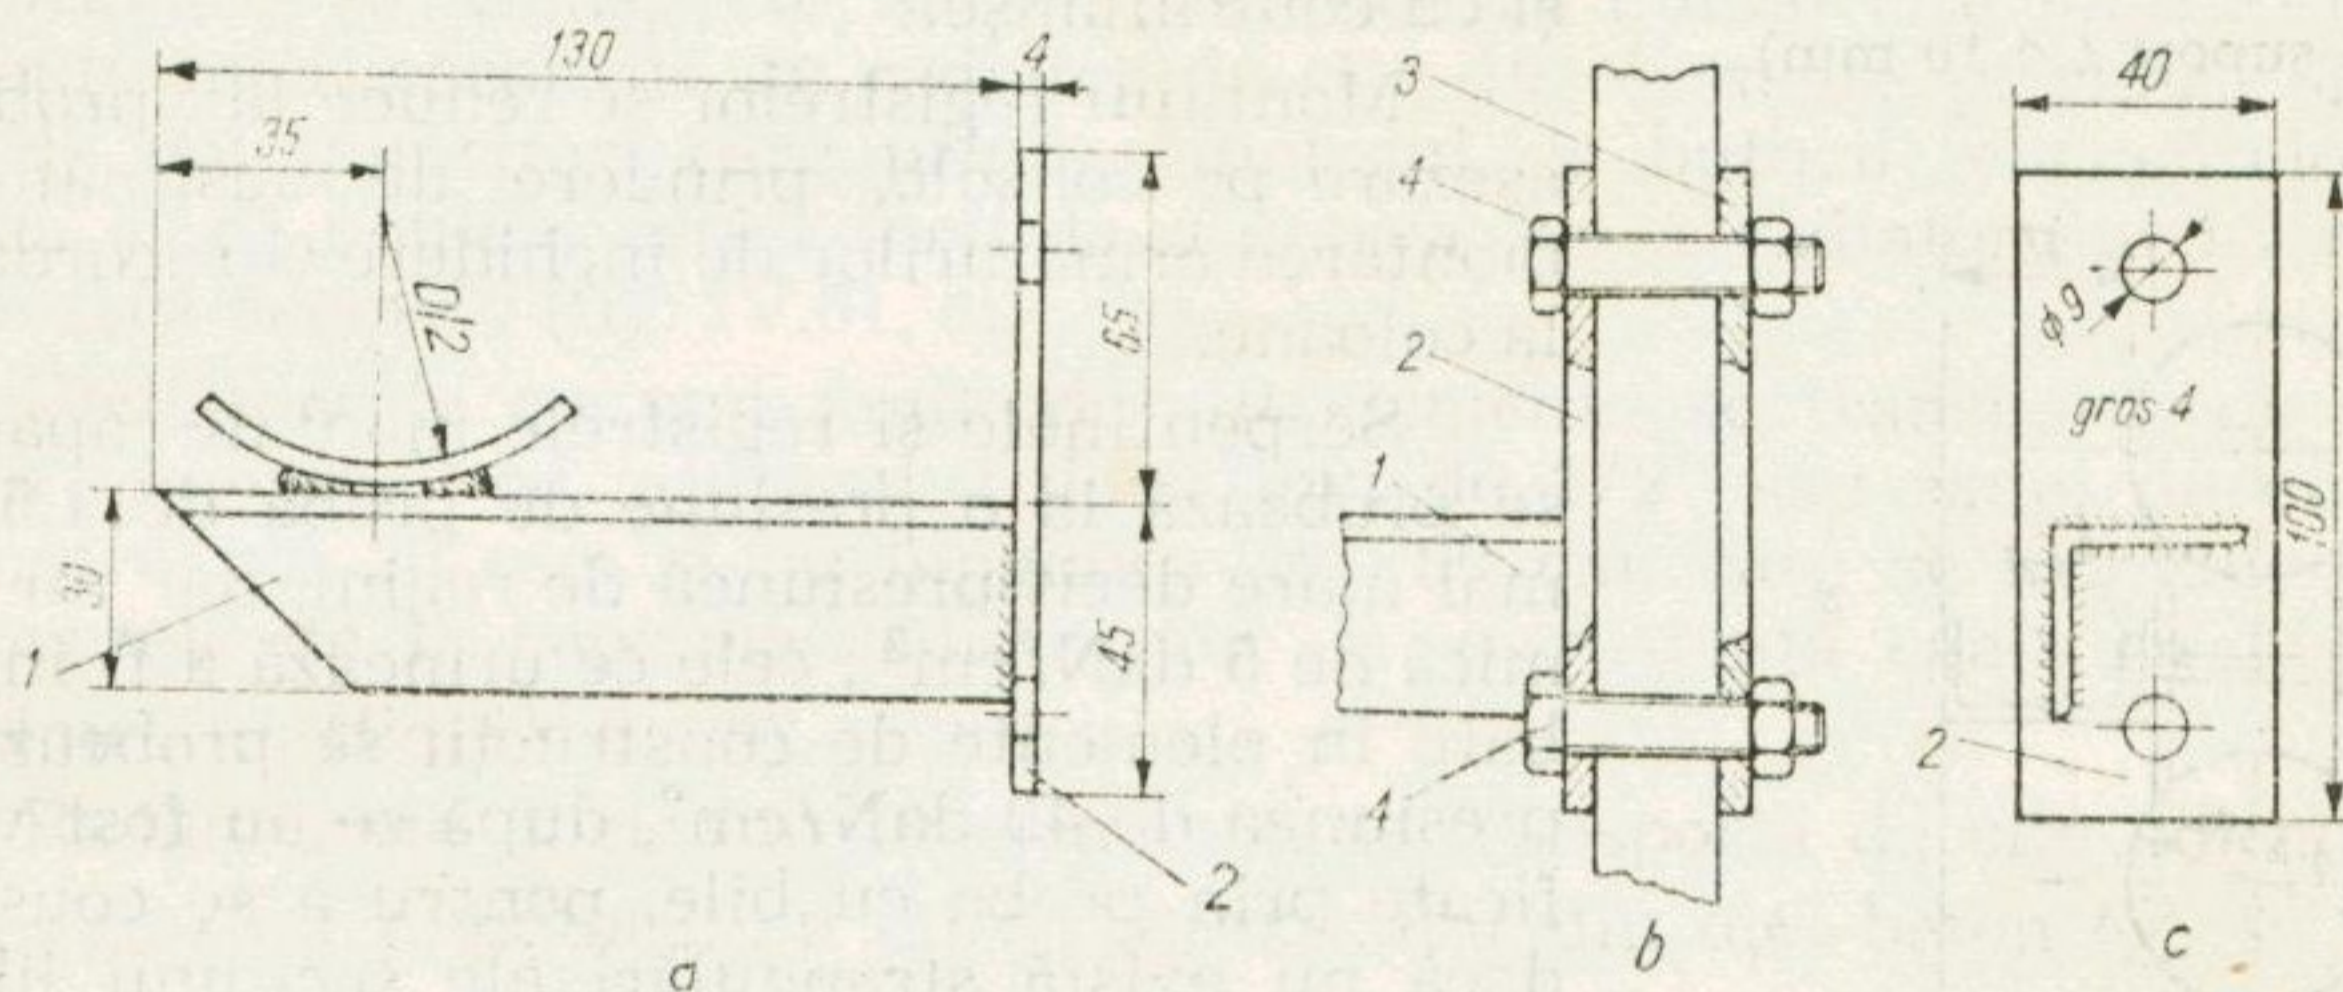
Consolă în perete prefabricat pentru registre :
